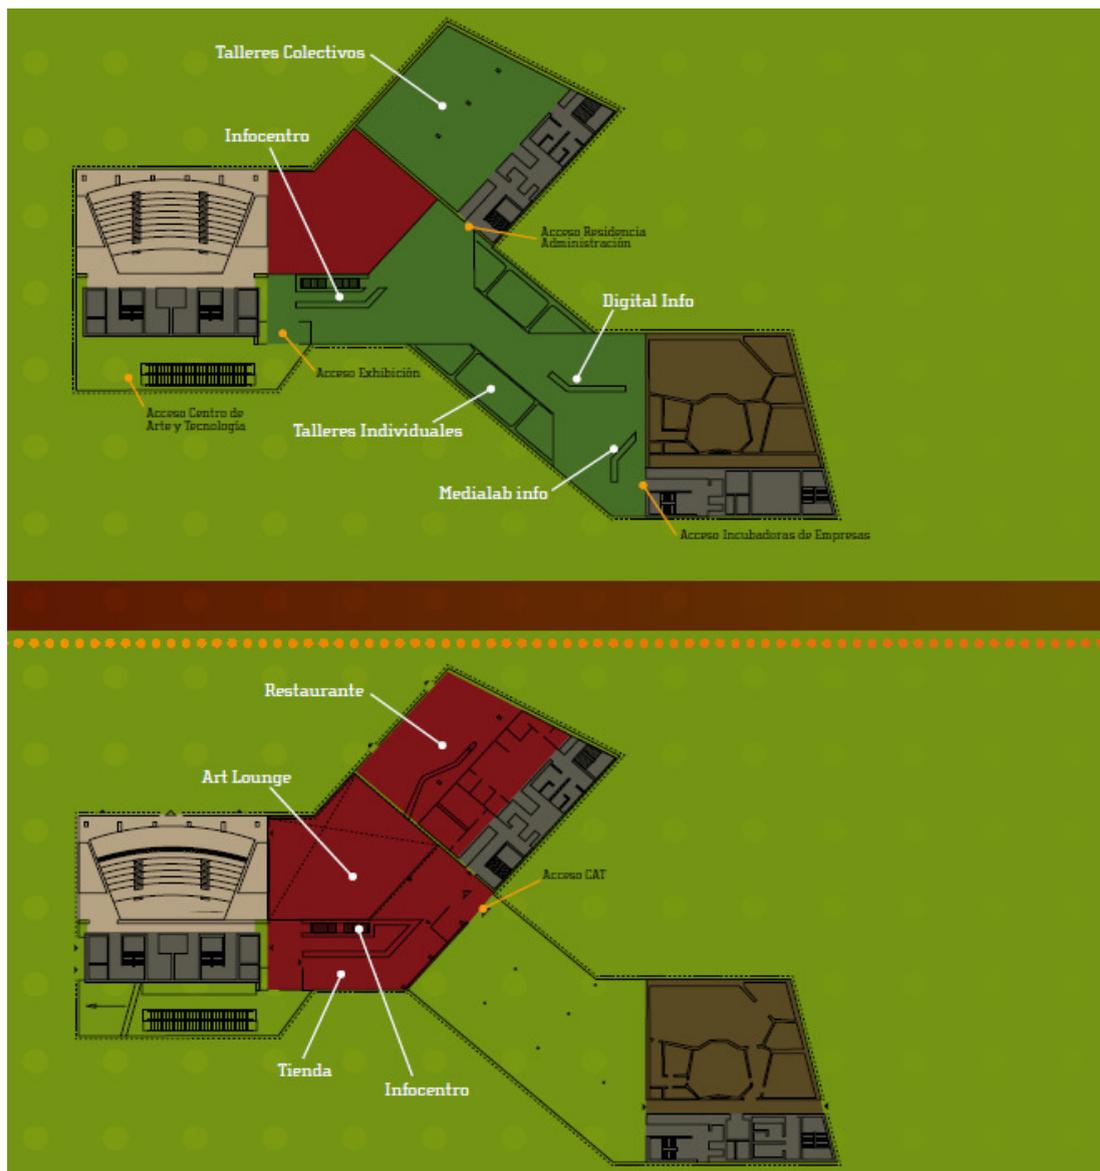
Proyecto CAyT - Esquema de planta y sección de usos
